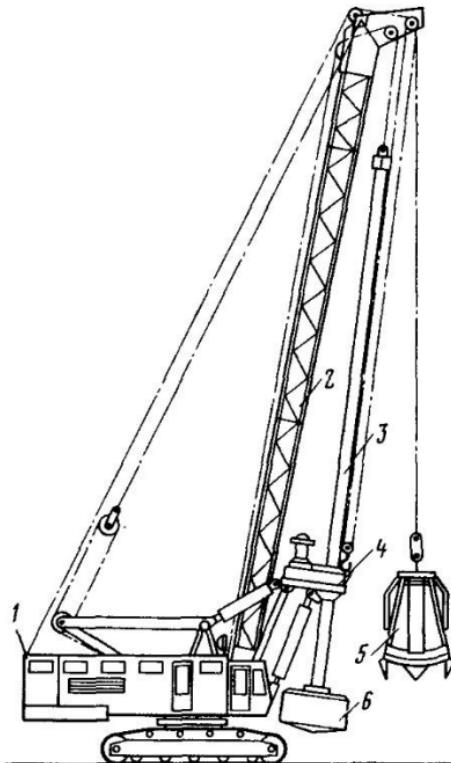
Навесное буровое оборудование МБС-1,7А:
